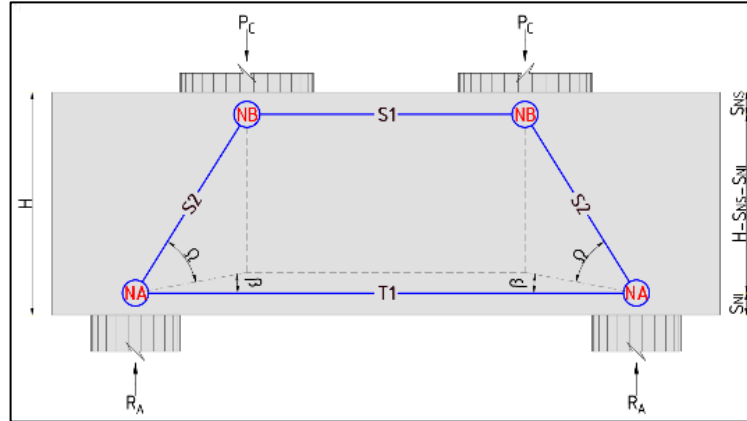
DADO DE PILOTES-PLANTA DEL RETICULADO-MPT
